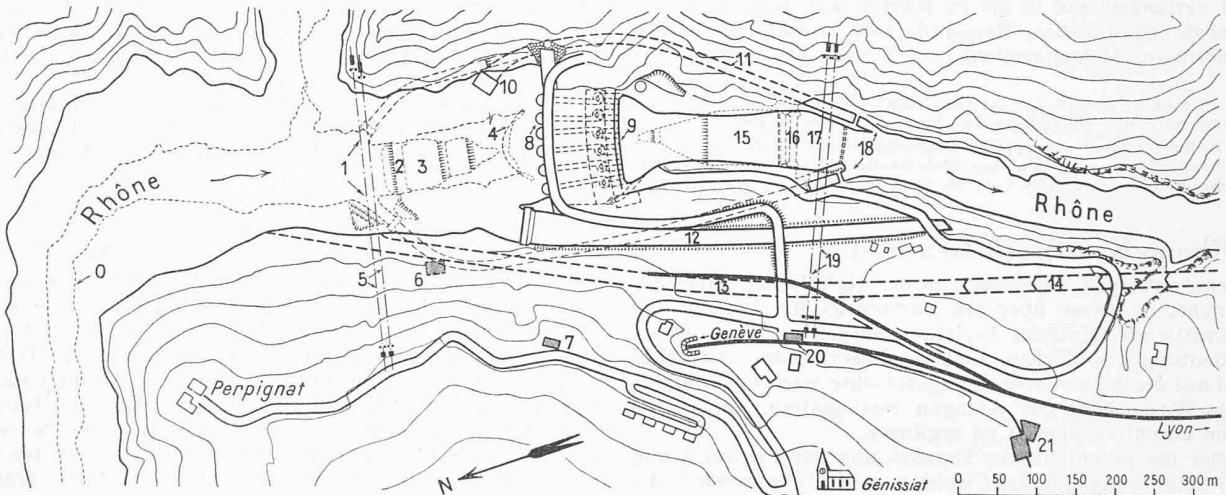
Kraftwerk Génissiat, Lageplan 1: 9400. — Legende: 0 ursprüngliches Rhonebett, 1 Umleitstollen, 2 oberer Fangdamm, 3 obere Steinschüttung, 4 gewölbte Hilfsstaumauer 40 m hoch, 5 Bau-Kabelbahnen, 6 Kiessandaufbereitung, 7 Transformatorstation, 8 Wasserfassungen und 9 Wasserrückgabe, 10 Einlauf des linksufrigen Entlastungsstollens 11, 12 offener Abflussgraben, 13 zukünftiger Schiffahrtsweg mit dreistufiger Schleusentreppe 14, 15 Materialdeponie, 16 unterer Fangdamm, 17 untere Steinschüttung, 18 Auslauf der Entlastungsstollen, 19 Bau-Kabelbahnen, 20 Station Génissiat, 21 Kalkbrennöfen. — Cliché «Elektrizitätsverwertung»
